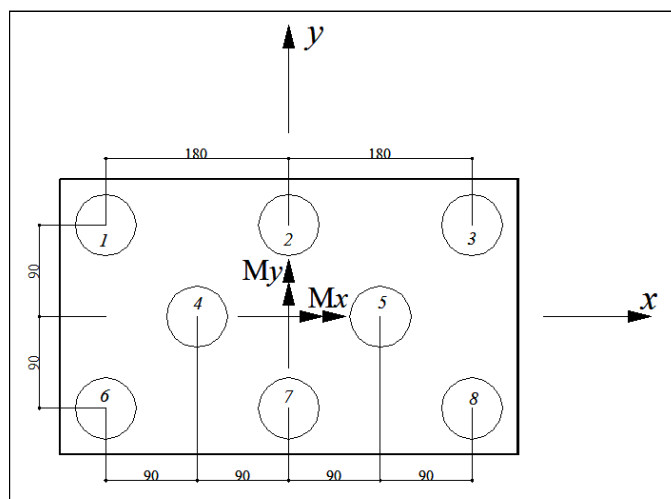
Planta baixa de um bloco sobre estacas (medidas em cm)
